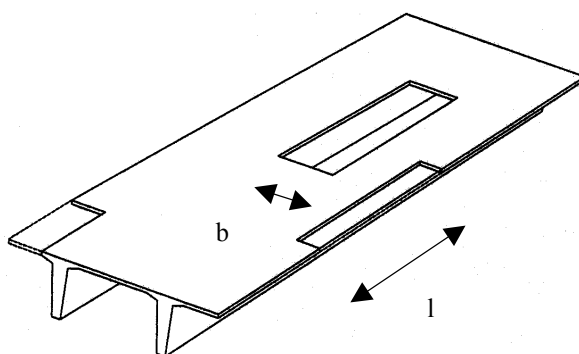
Raveelconstructie voor brede openingen in holle vloeren
